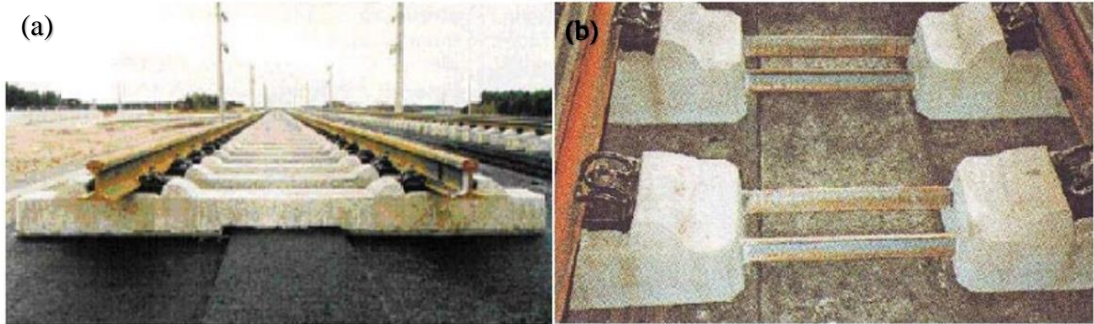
Stedef sisteminde kullanılan travers blok yapısı
